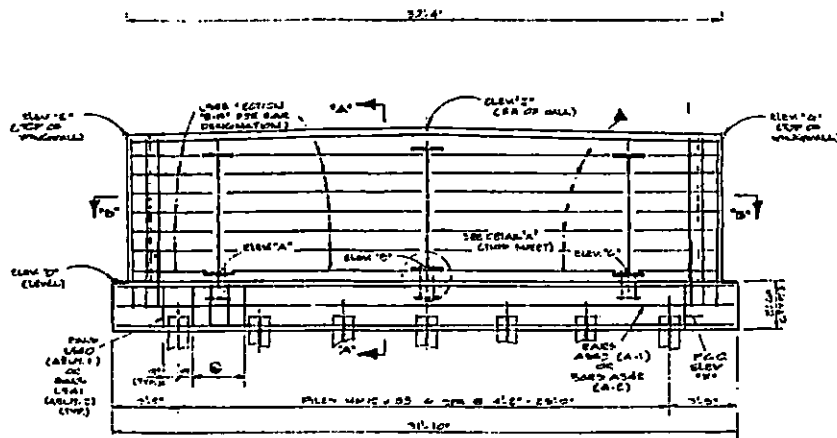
DETALLE DEL ESTRIBO.
